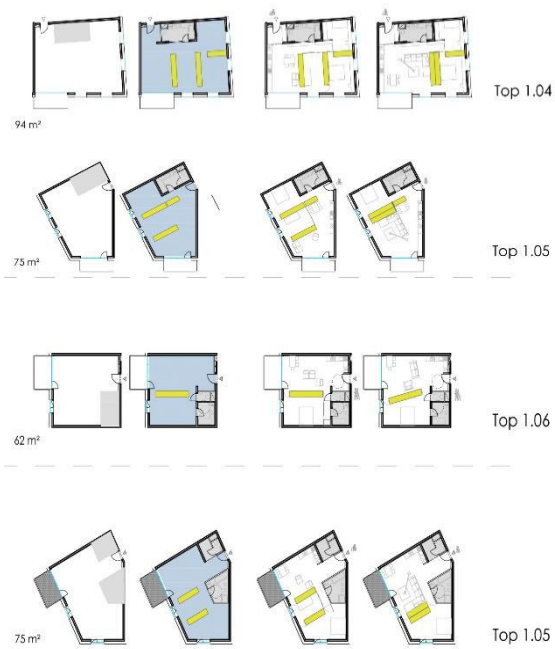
Sonnendviertel, Bauteil C1, Grundrissvarianten
